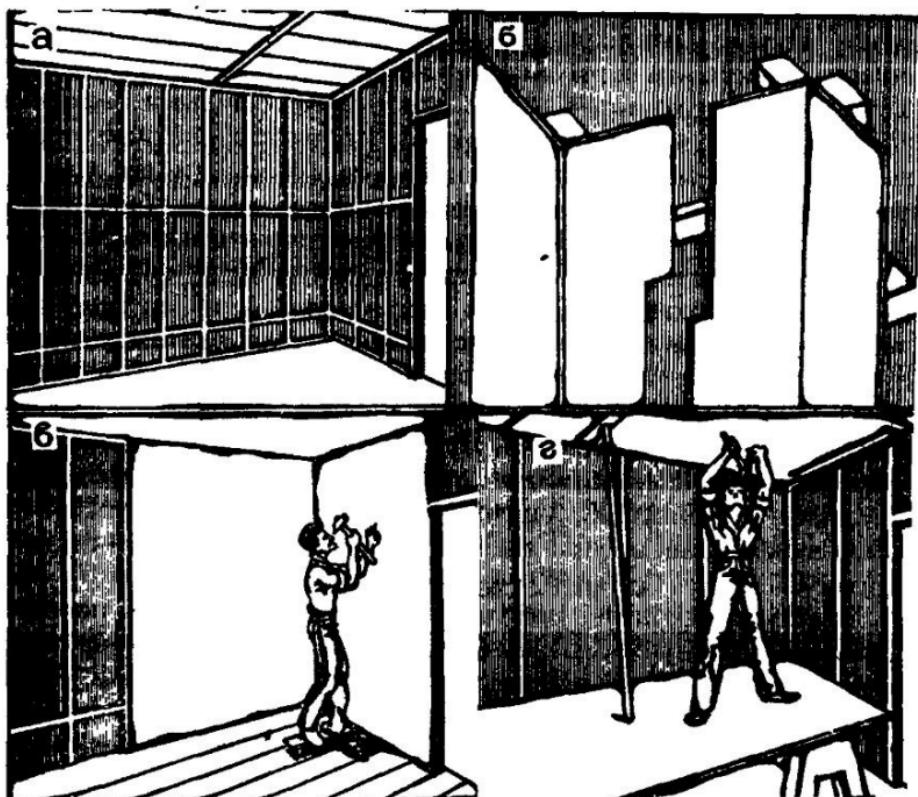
Обшивка стен и потолков древесноволокнистыми плитами:
